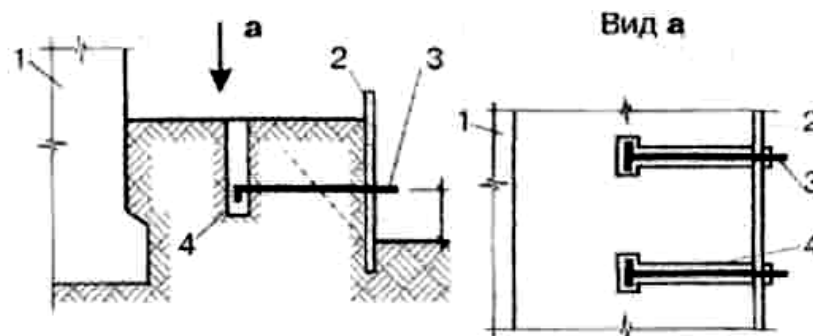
Схема анкерного кріплення: 1 – існуючі конструкції; 2 – захисна конструкція; 3 – анкер; 4 – траншея для влаштування анкера
